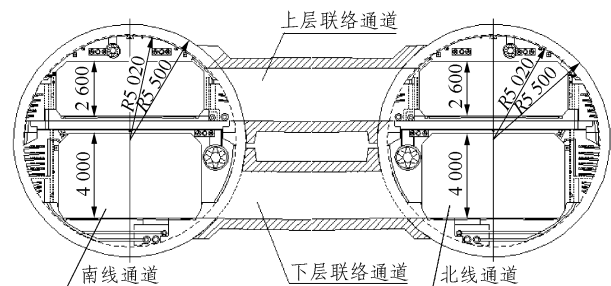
复兴东路双线盾构隧道横断面布置图(单位: mm)
